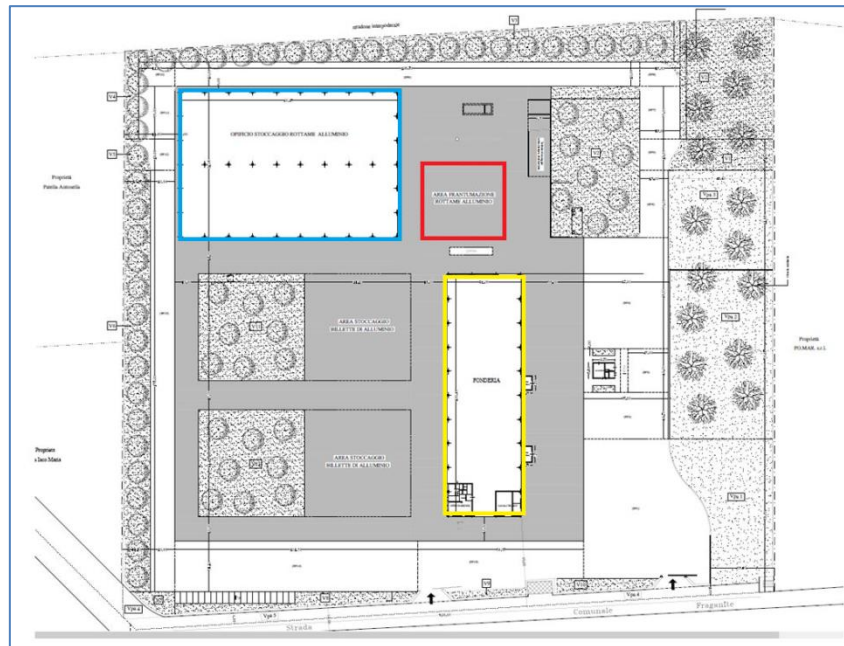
localizzazione nuovo impianto di raffinazione rottame di alluminio rispetto alla fonderia e alla nuova tettoia
